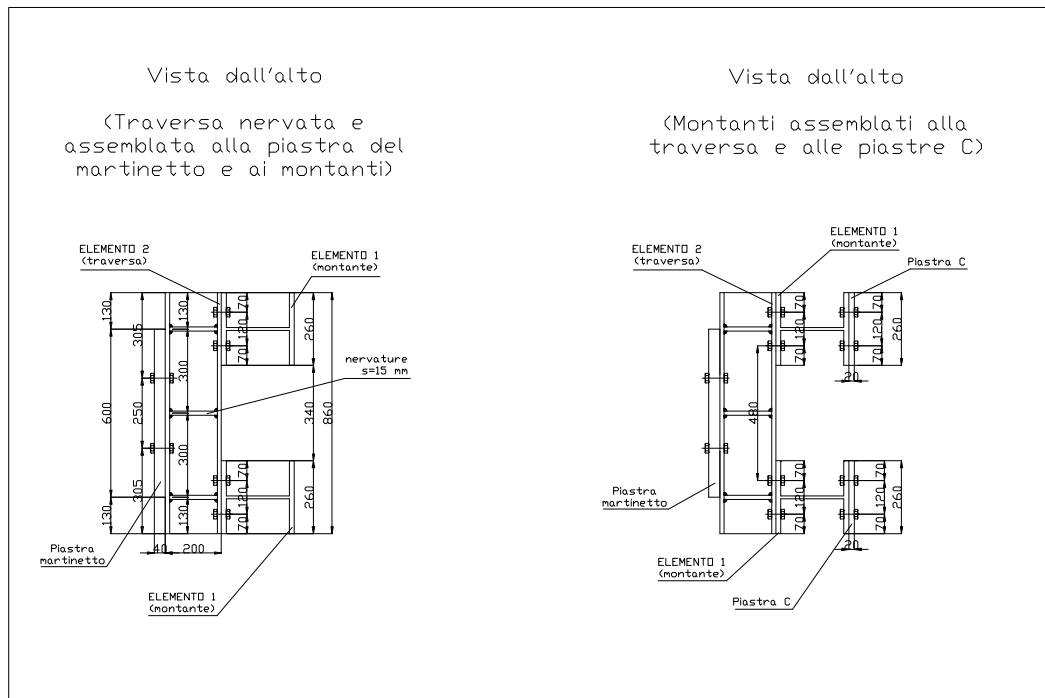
Viste dall'alto degli HE B 200 assemblati ai montanti e alla piastra del martinetto.
